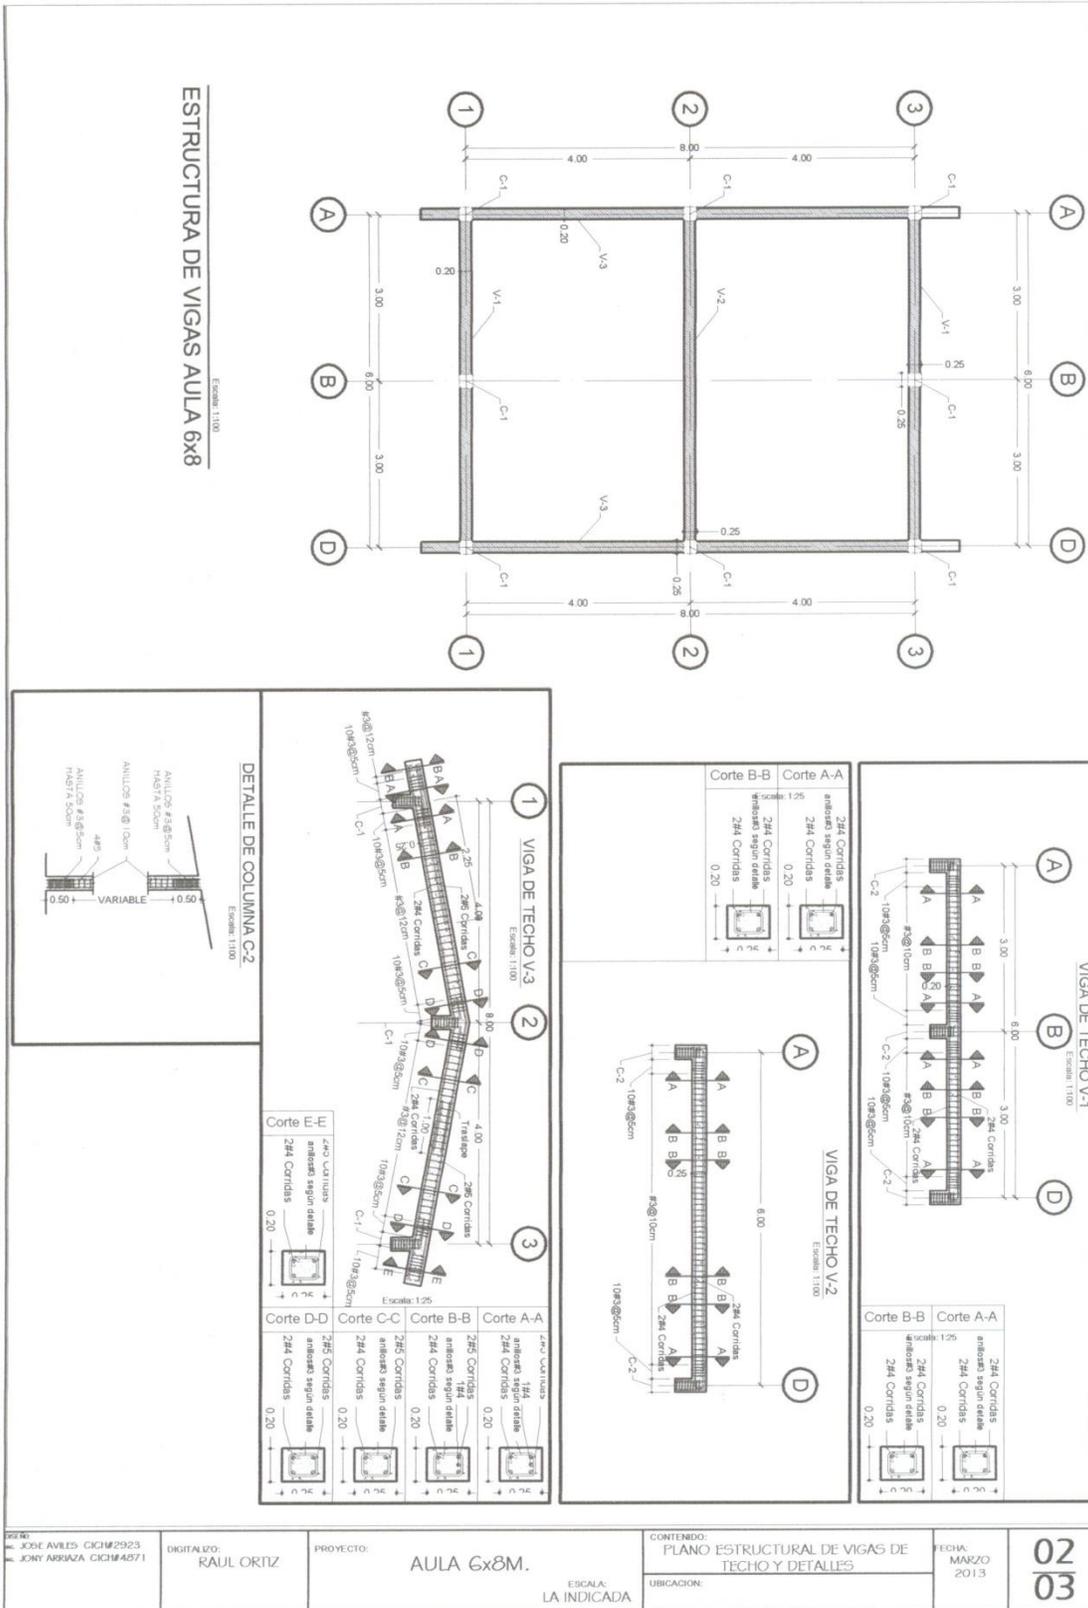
Plano Estructural de Techo Centro Escolar Aula Tipo I Nivel 6X8m.
